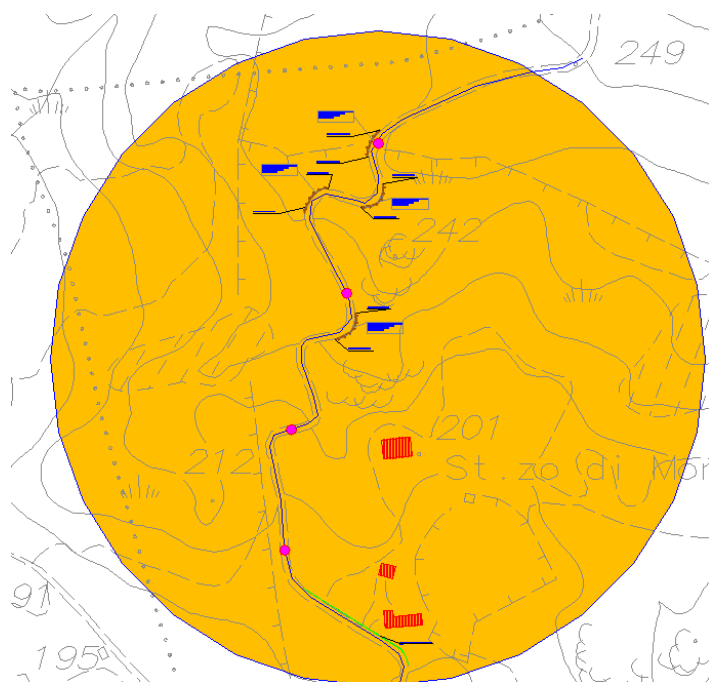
Comune di Arzachena – Strada Monticanu - Estratto planimetria di intervento
